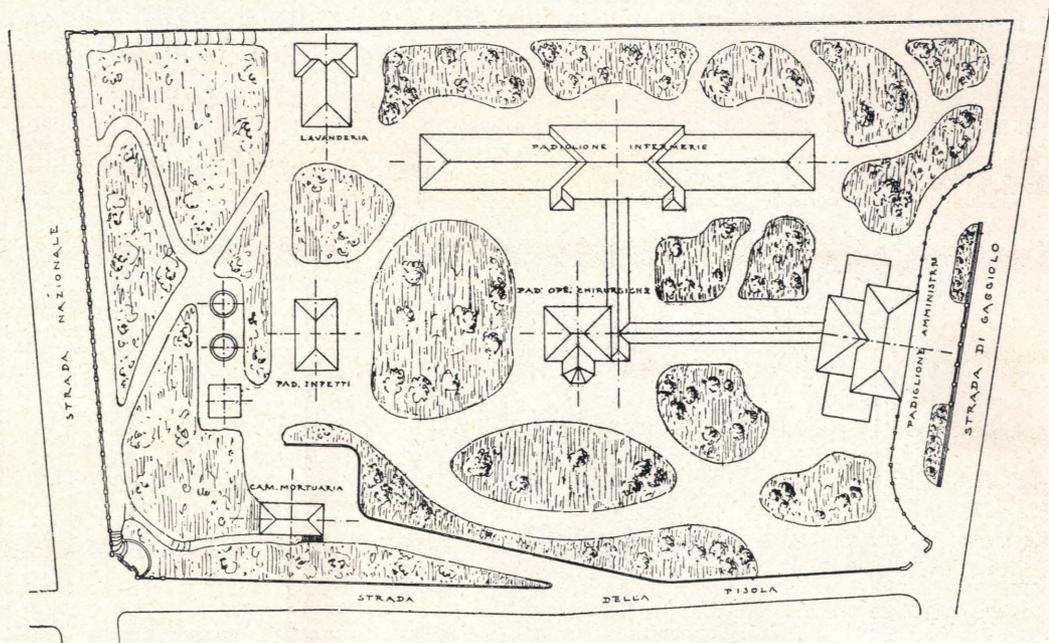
Nuovo Ospedale di Oleggio. Planimetria generale.
